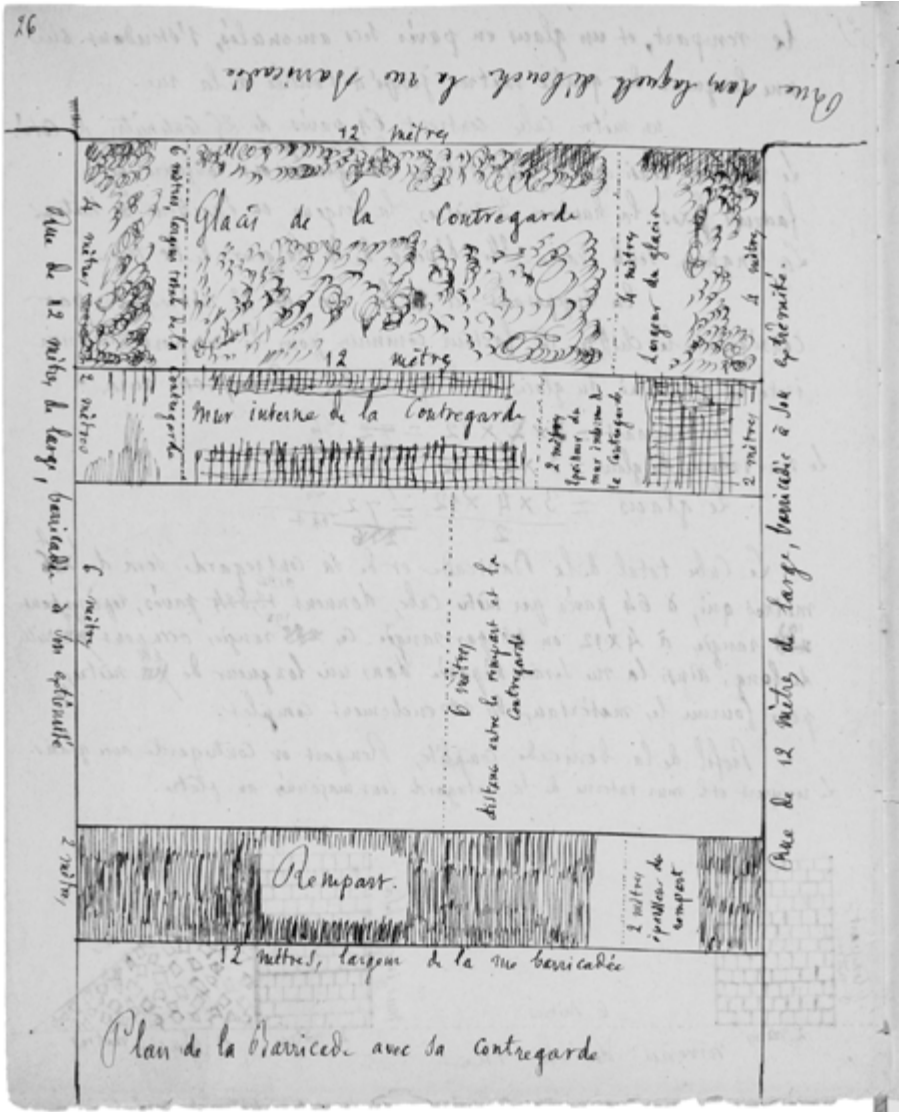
Plan der Barrikade mit ihrem Vorwall.
